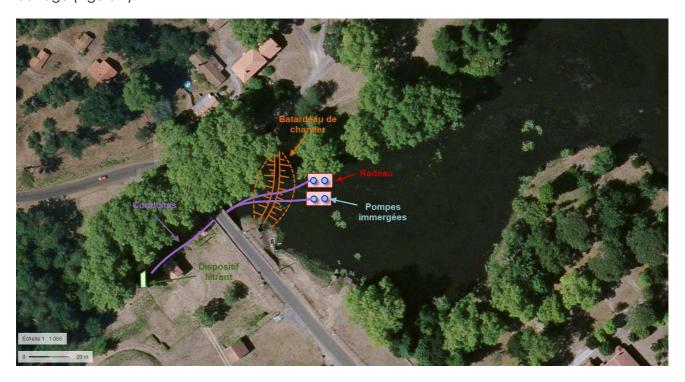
Schéma d'implantation du batardeau de chantier et du dispositif d'abaissement du niveau de la retenue (ISL, 2019)
